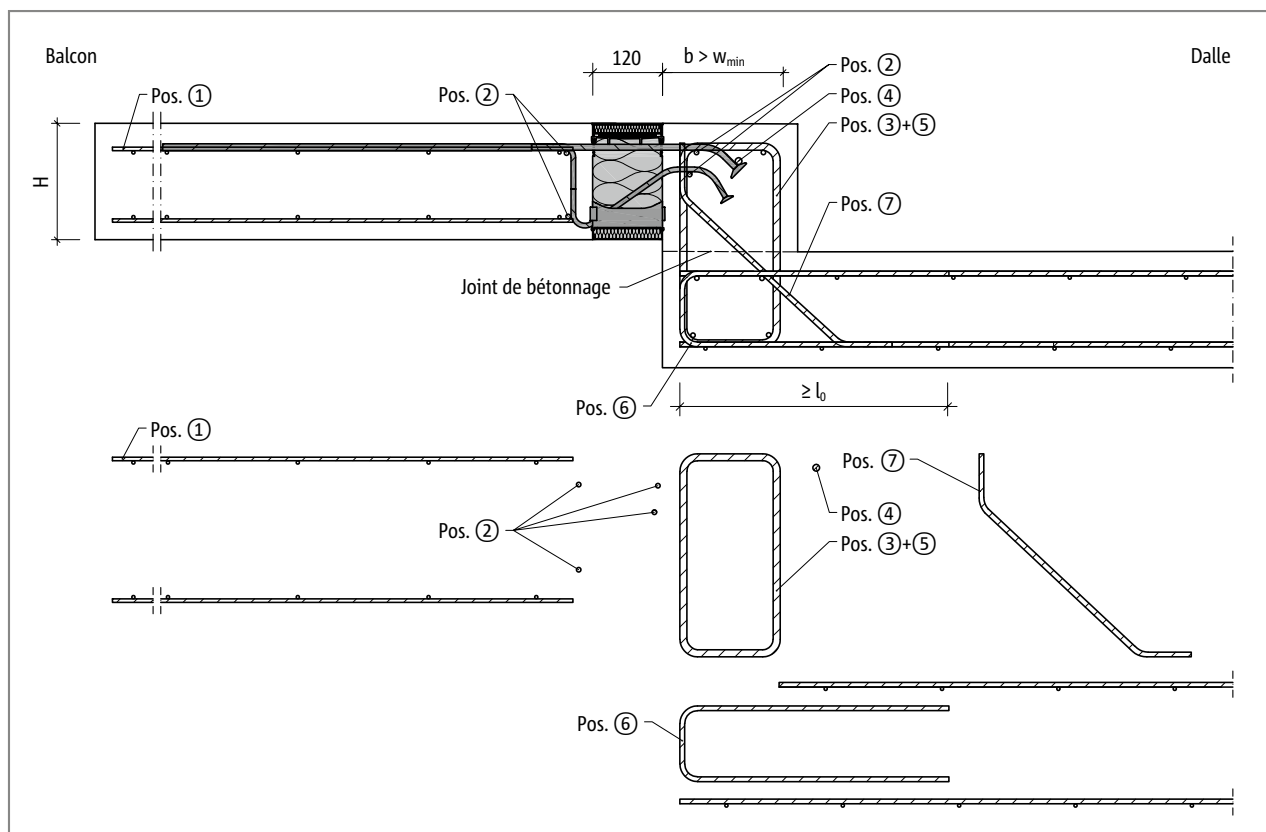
Schöck Isokorb® XT type K-O : Renfort sur site pour balcon décalé en hauteur vers le haut, avec dimensions supérieures des composants ($w_{vorb} > w_{min}$)
